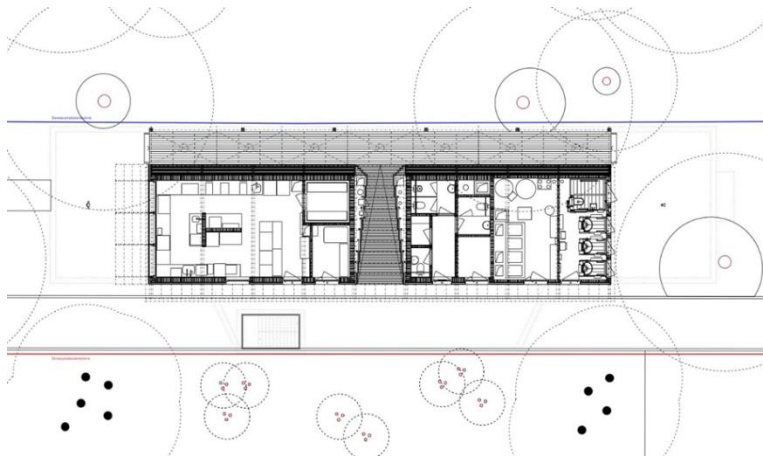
Grundriss Verpflegungskiosk und ZüriWC.
